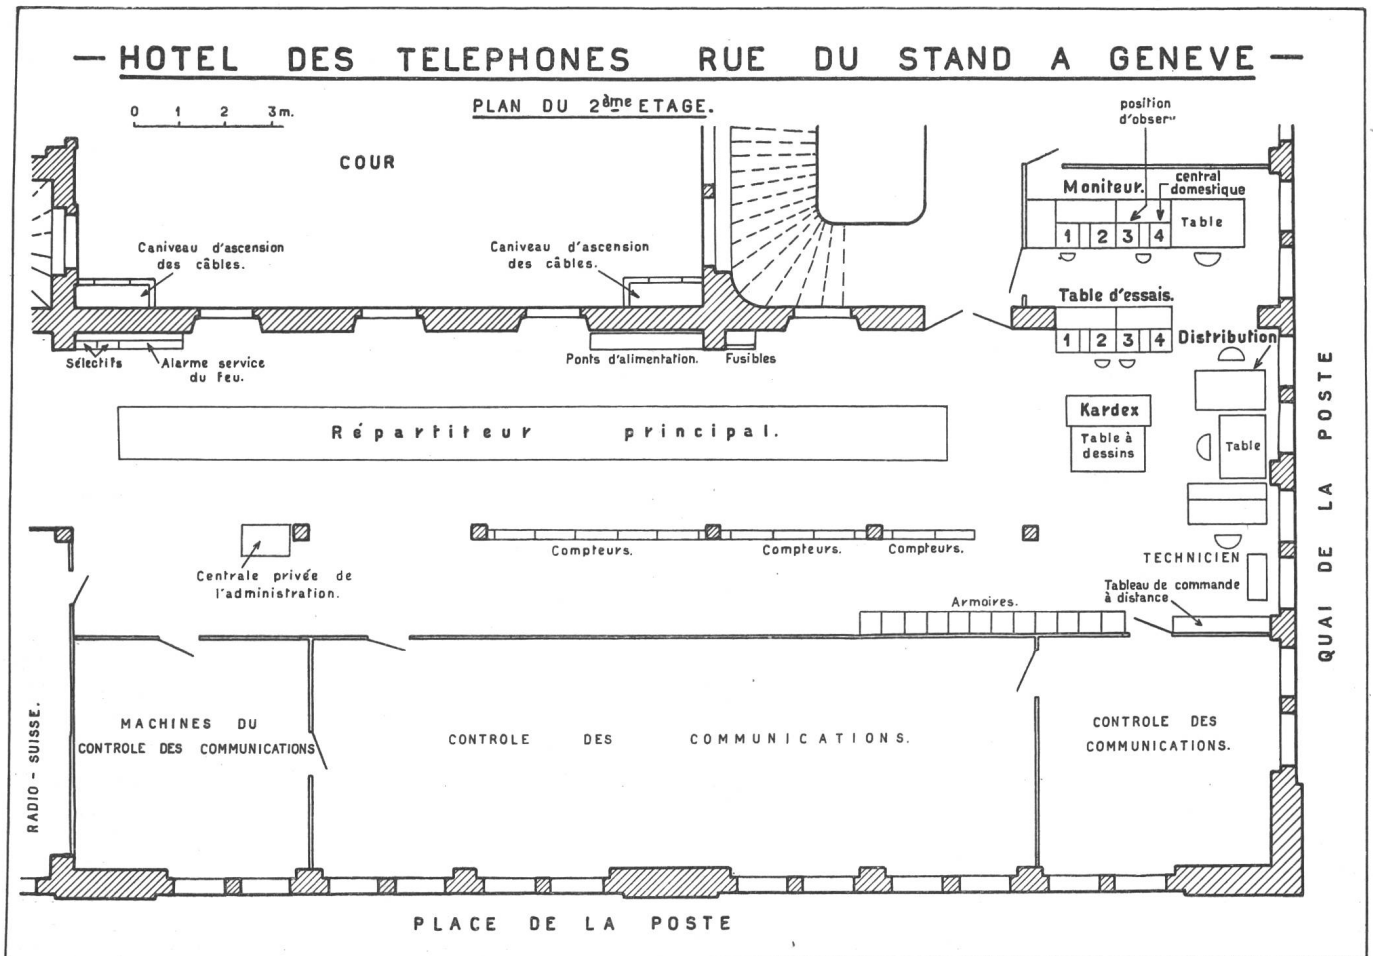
Plan des II. Stockwerkes. — Plan du 2^me étage.
